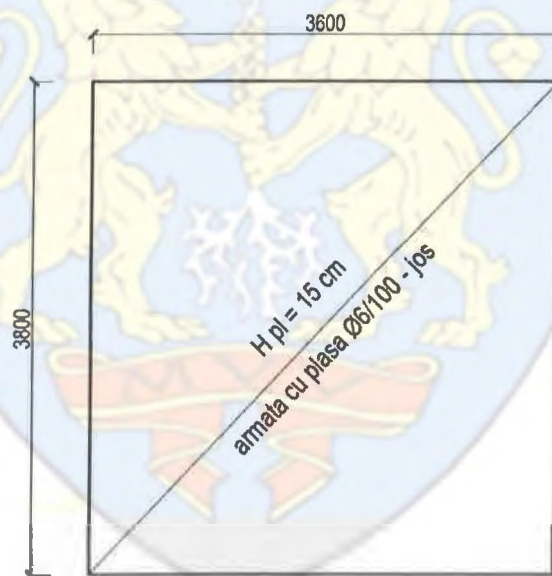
Planul de structură al platformei de beton a grupului sanitar propus
